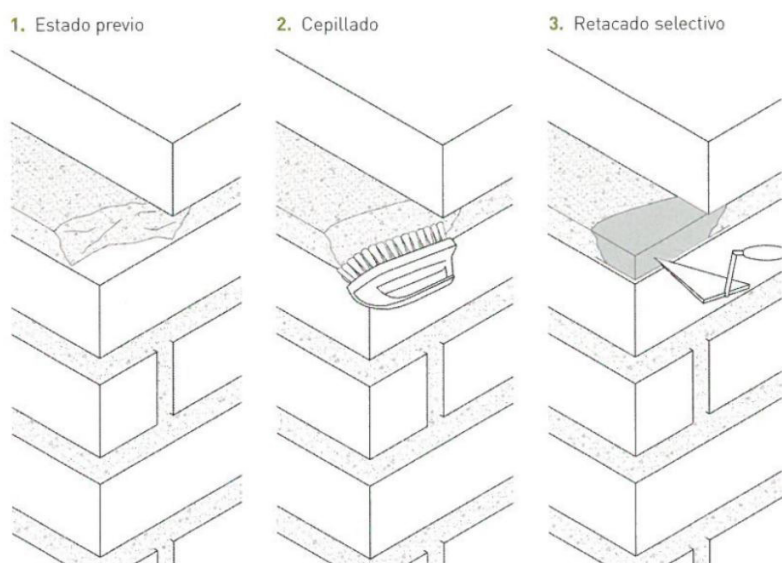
Detalle de rejuntado con mortero, F. Vegas y C. Mileto (24)
